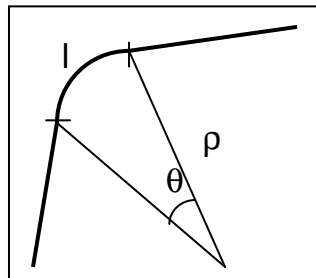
Planta de la traçada en tram corb d'una conducció lliure.
